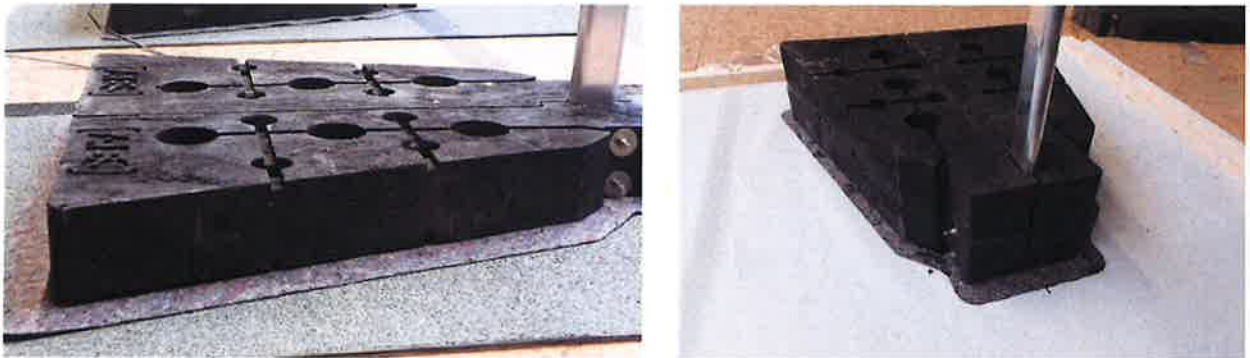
13: Simulierte Bauwerksoberfläche (Bitumen-Dachbahnen links und PVC-Folie rechts) mit rutschhemmender Matte
